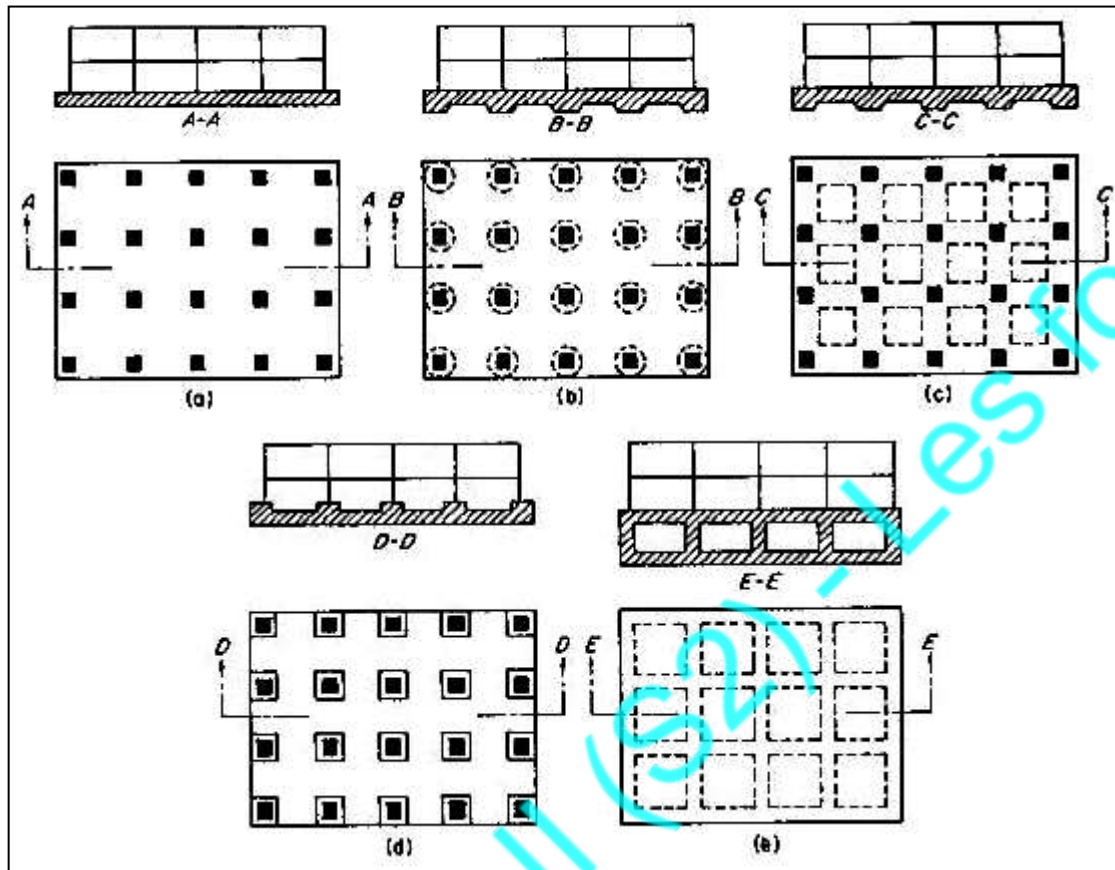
Quelque type courants de fondation sur radier [bouafia]
